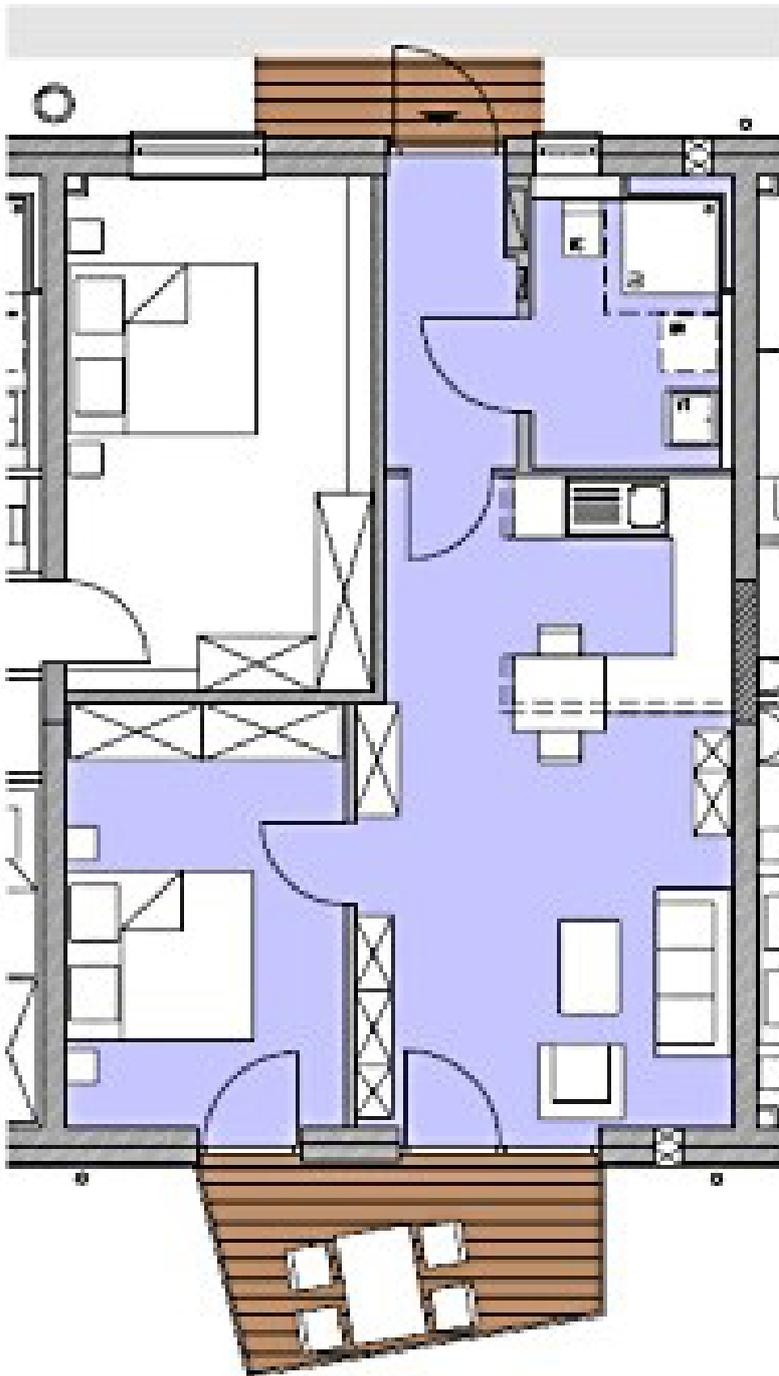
Grundriss PrymPark für Wohnung mit 60 Quadratmeter
